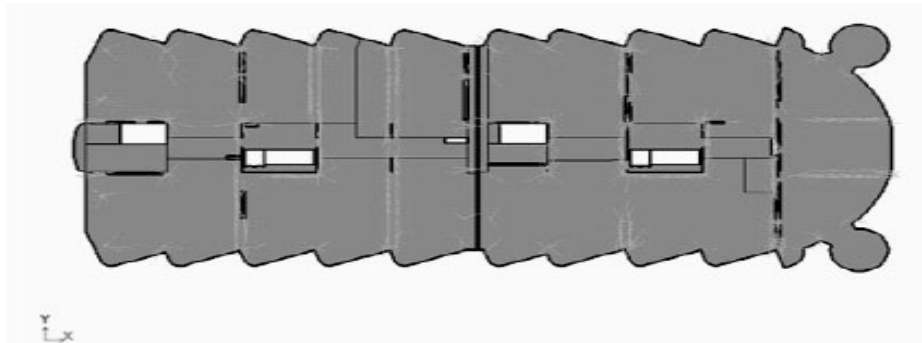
Напрямок тріщин у нижньому шарі плити перекриття
